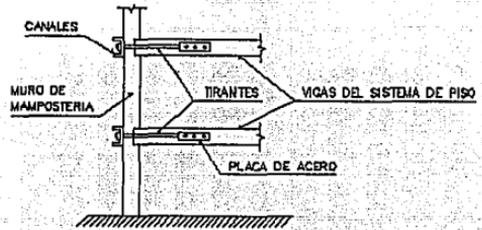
Anclaje de muro exterior a vigas de los sistemas de piso.
